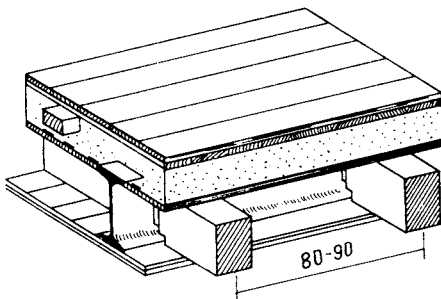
Перекрытие средней степени воспламеняемости из балок, уложенных на двутавр
